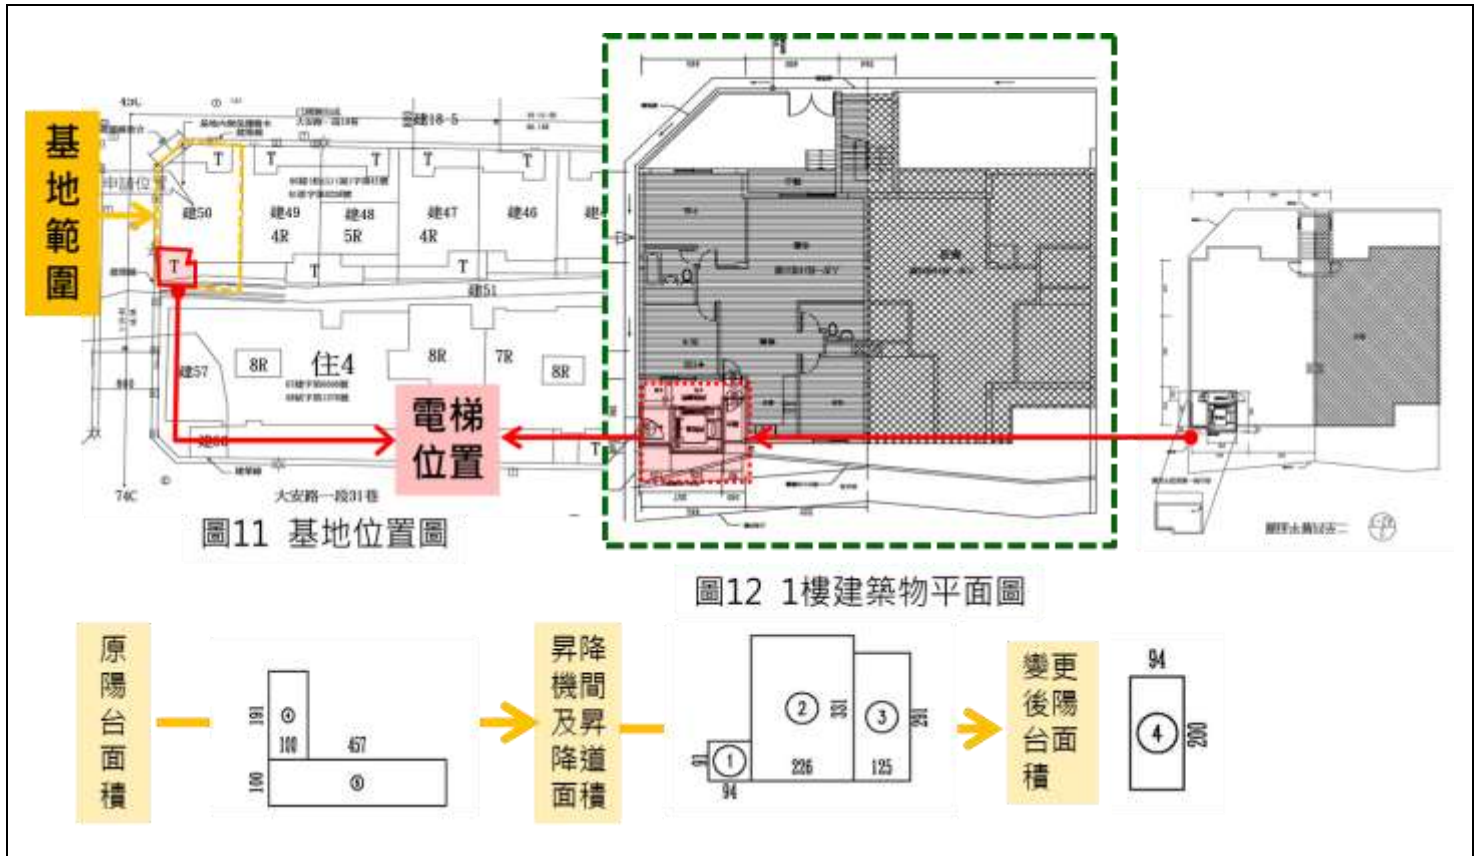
案例 3-1 昇降機增設位置說明示意圖
